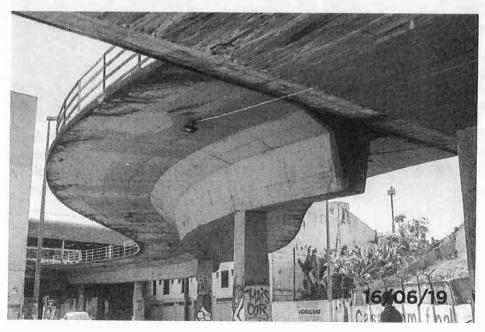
Vista da iluminação, infiltração, desplacamento e fissuras da parte infeiror da passarela no encontro com Av. Brasil.
